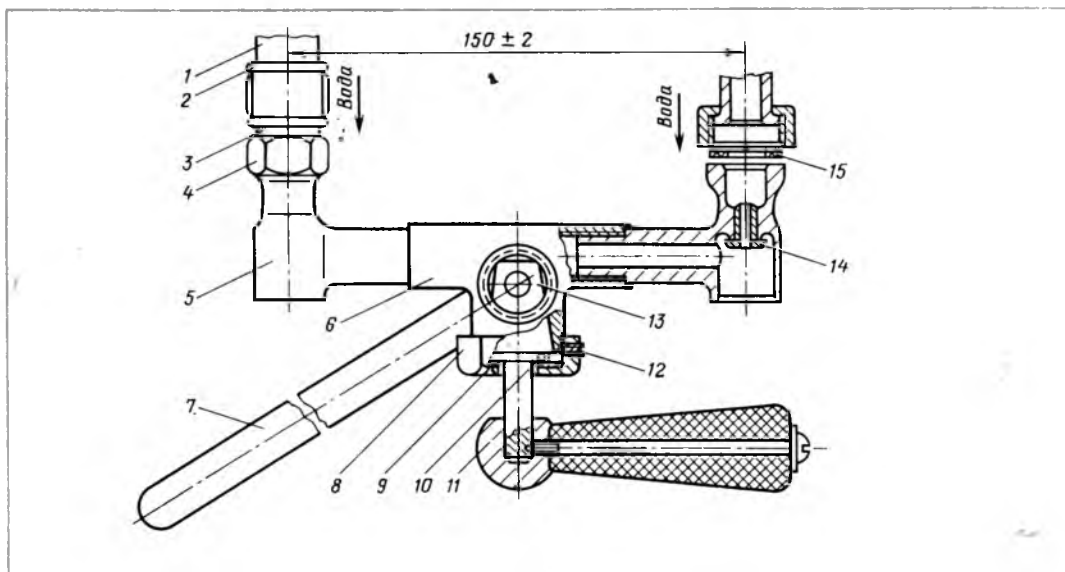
Смеситель с пробковым переключателем: 1 — подводящая труба; 2 — муфта; 3 — втулка; 4 — накидная гайка; 5 — боковина; 6 — корпус; 7 — извив; 8 — накидная гайка; 9 — шайба латунная; 10 — ограничитель; 11 — остов; 12 — стопорный винт; 13 — конус подвижной (конусная пробка); 14 — втулка ремонтная; 15 — прокладка
